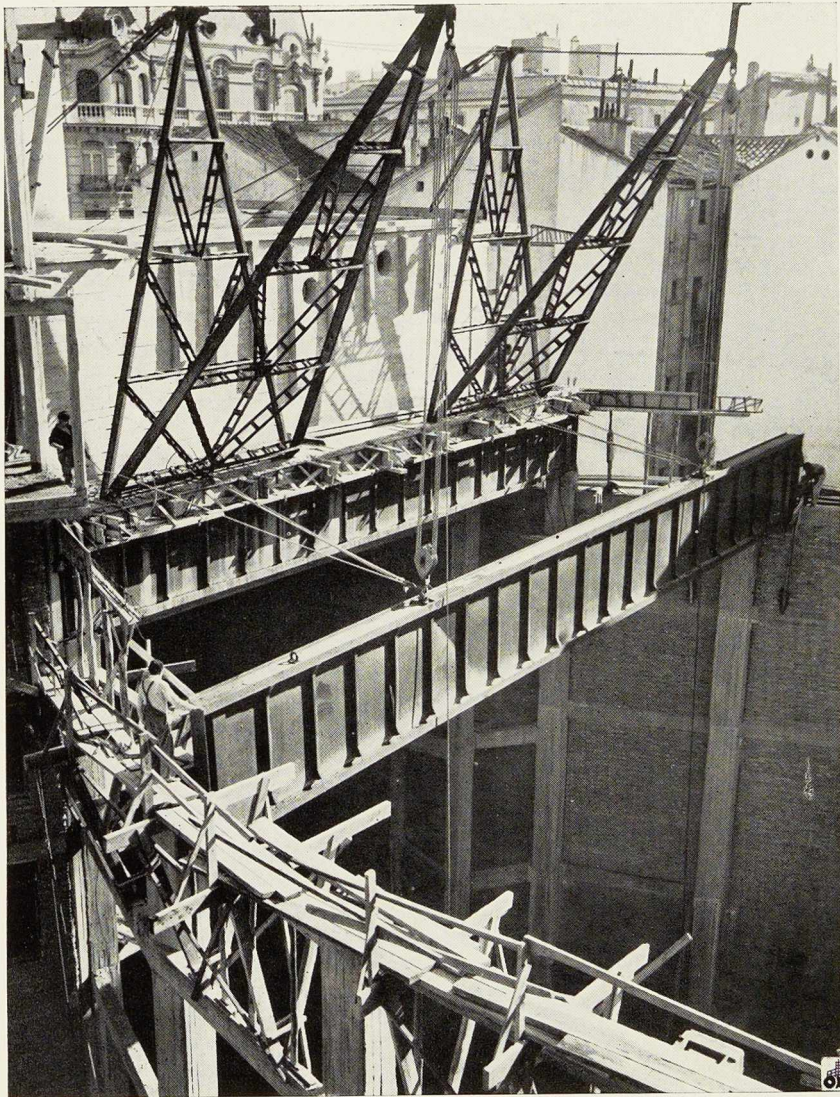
Vue générale du chantier. Mise en place de la poutre II au moyen de 2 derricks.
